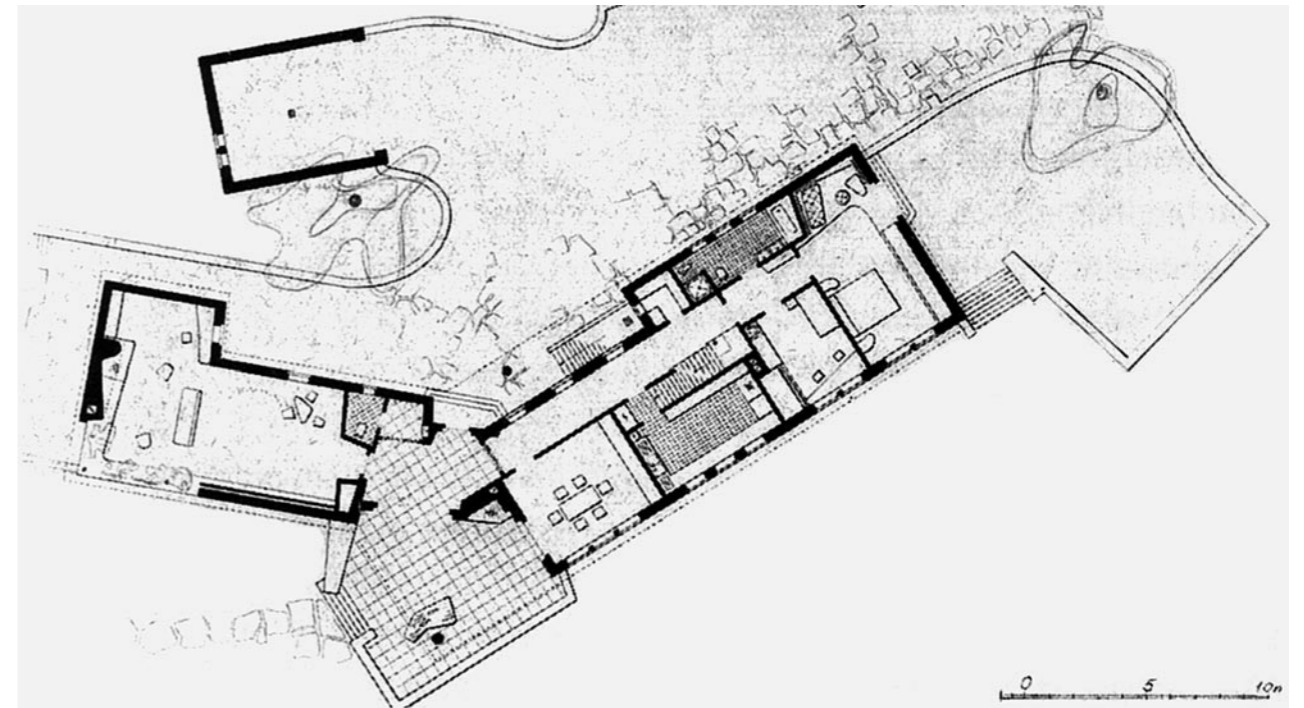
Paul Stohrer, Villa Widenmeyer, München, 1949–50; Grundriss.
